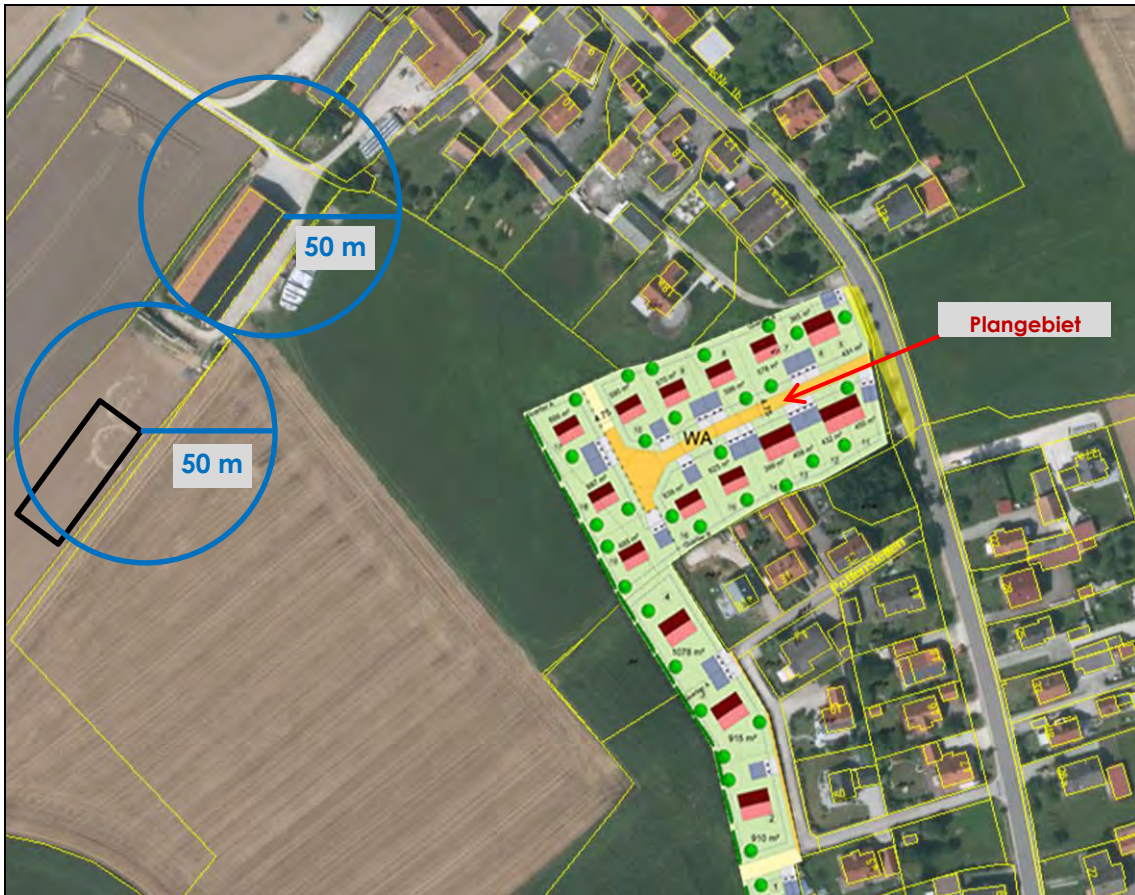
Lageplan mit Darstellung des Mindestabstands Gärfuttersilo - Wohngebiet
